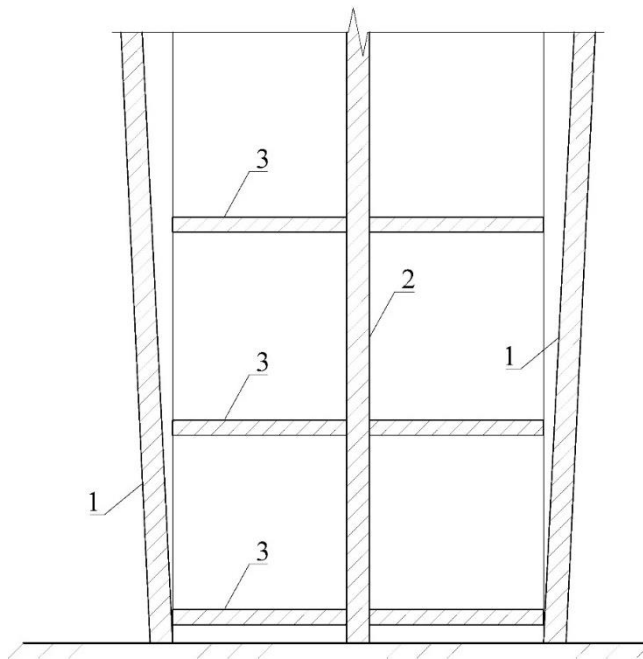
Принципиальная схема дефекта - крен стен: 1 – наружная стена, отклонившаяся от вертикали; 2 – внутренняя стена; 3 – перекрытие.
